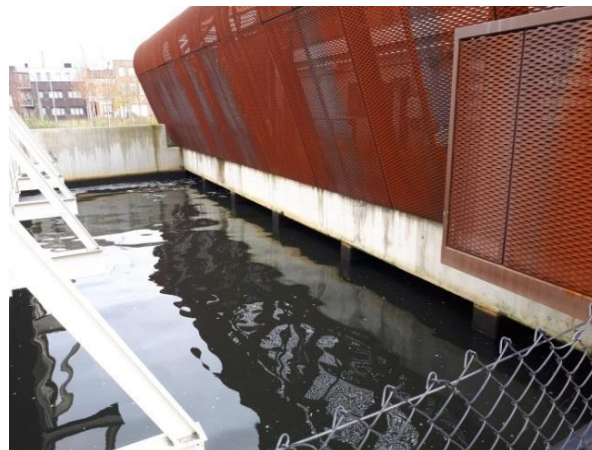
De uitstroomopeningen stroomafwaarts van de buis- en stormvijzels van het PGGs. In de bestaande betonnen geleiders van het gemaal (niet zichtbaar op foto) werden de kaders met fuikconstructie en Noors leefnet bevestigd.
